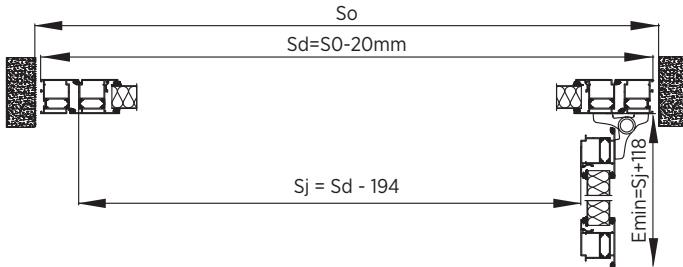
Montaggio in foro - sezione orizzontale - porta a un'anta - sistema MB60E.
